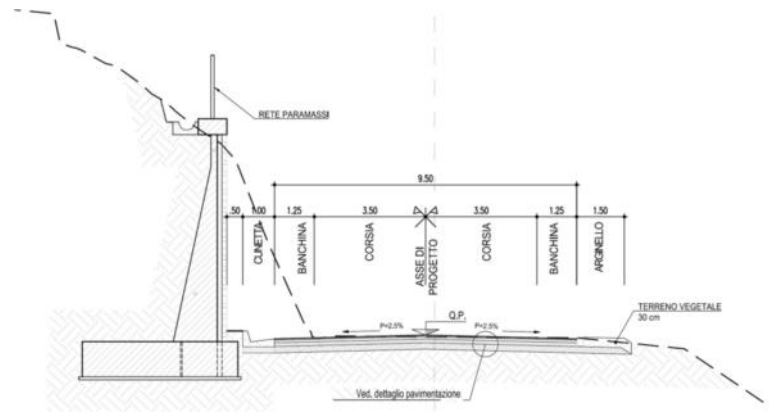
Sezione tipo con muro di controripa in progetto (lato monte)
